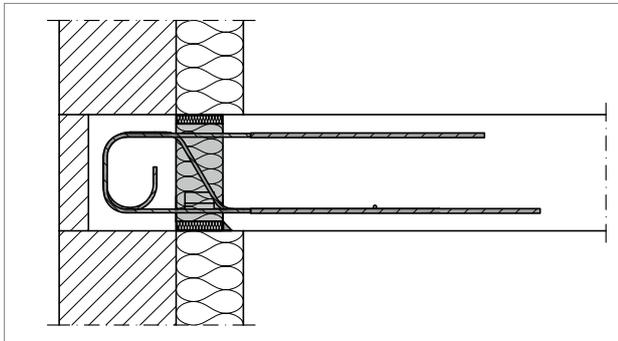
Schöck Rutherma® T type DF*i* : liaison pour façade en maçonnerie et dalle en béton coulé sur place
